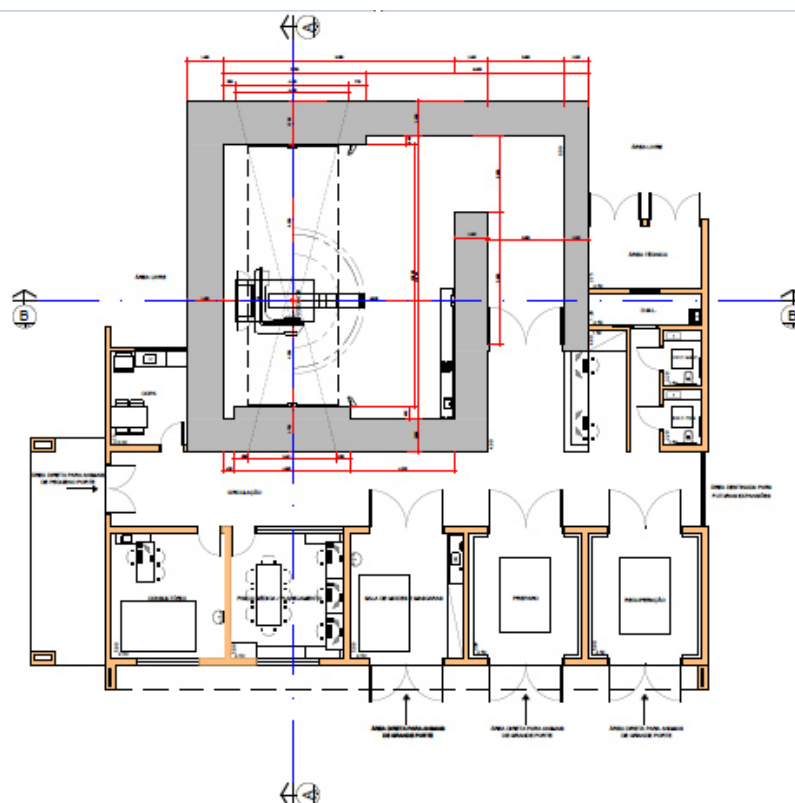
Planta baixa de um serviço de radioterapia. Fonte: FERNANDES, 2018.
